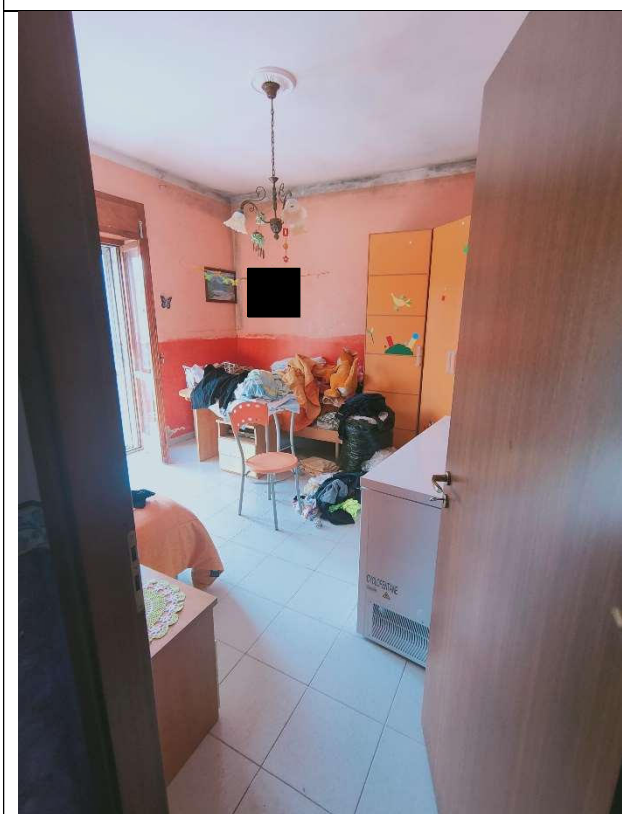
VANO CAMERA 3 CON AFFACCIO BALCONATO SULLA CORTE ESTERNA SUB 1
